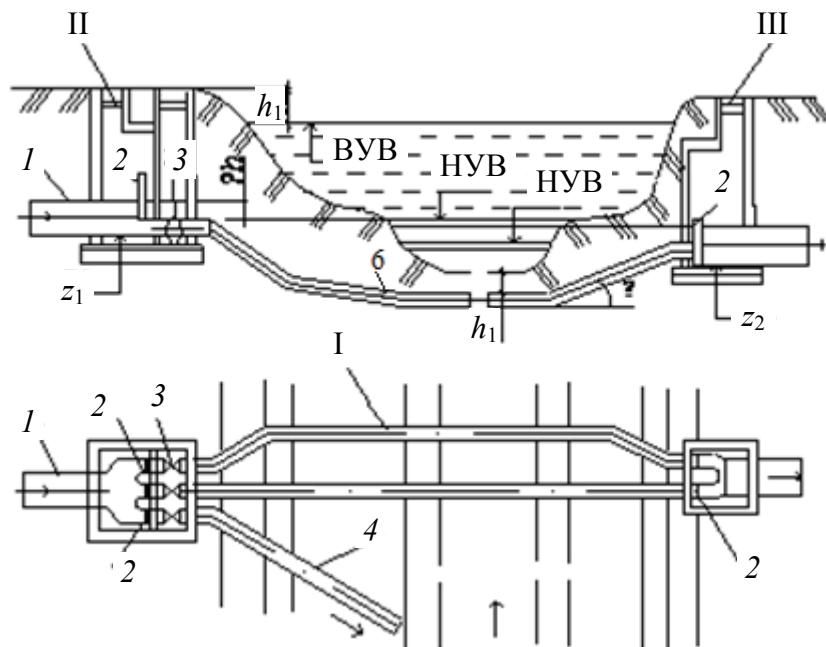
Схема дюкера через реку: I – напорные трубопроводы; II – верхняя камера; III – нижняя камера; 1 – подводящий самотечный трубопровод; 2 – щитовые затворы; 3 – задвижки; 4 – аварийный выпуск
